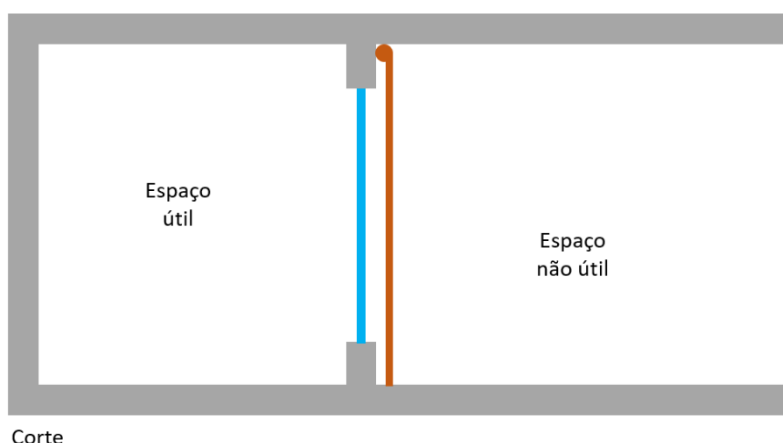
Área efetiva coletora de um vão envidraçado (estação de aquecimento).
